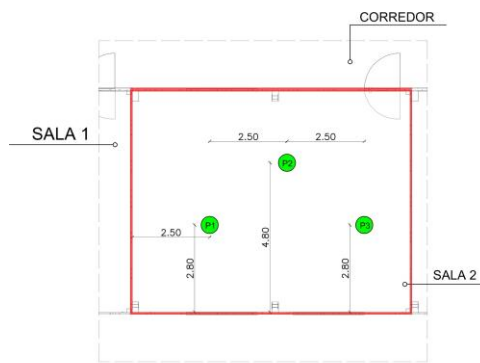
Situação 6 – Fachada (Emissão) e Sala 2 (Recepção)
